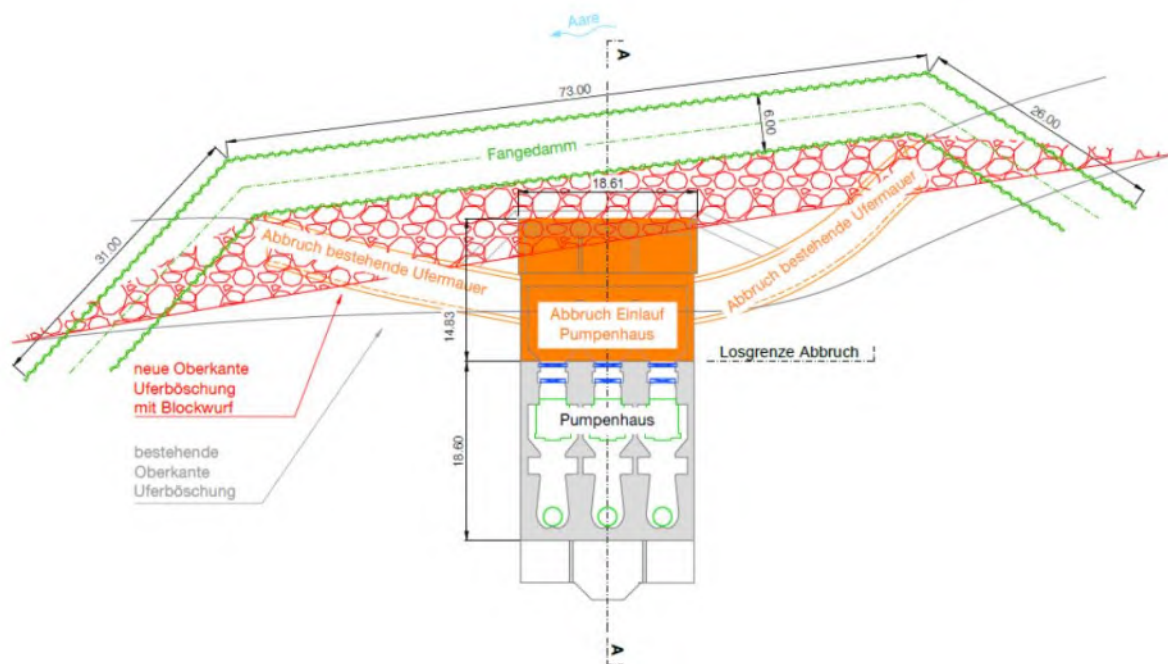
Grundriss Rückbau Einlaufbauwerk
